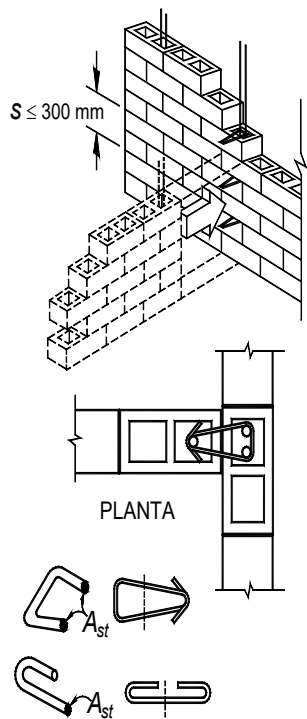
CONECTORES ENTRE MUROS SIN TRASLAPE DE PIEZAS
